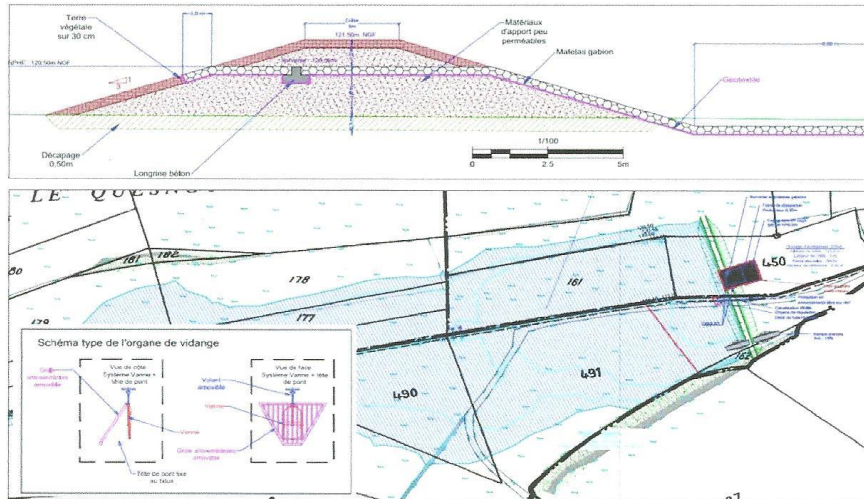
Extrait du plan de masse – Ouvrage D19-8
